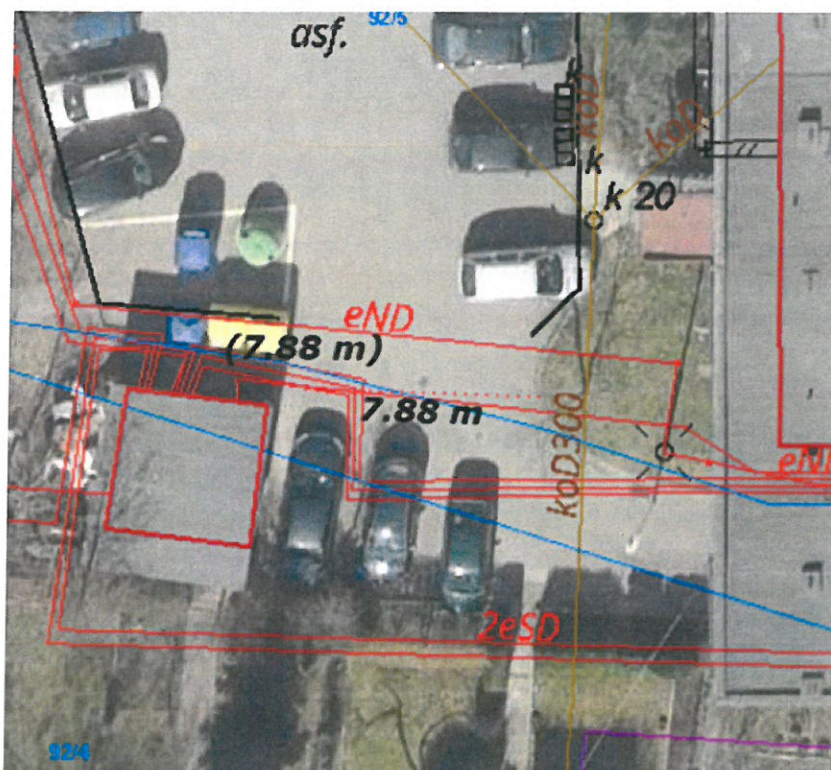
Planowane posadowienie szlabanu przy ul. Słonecznej 78.
